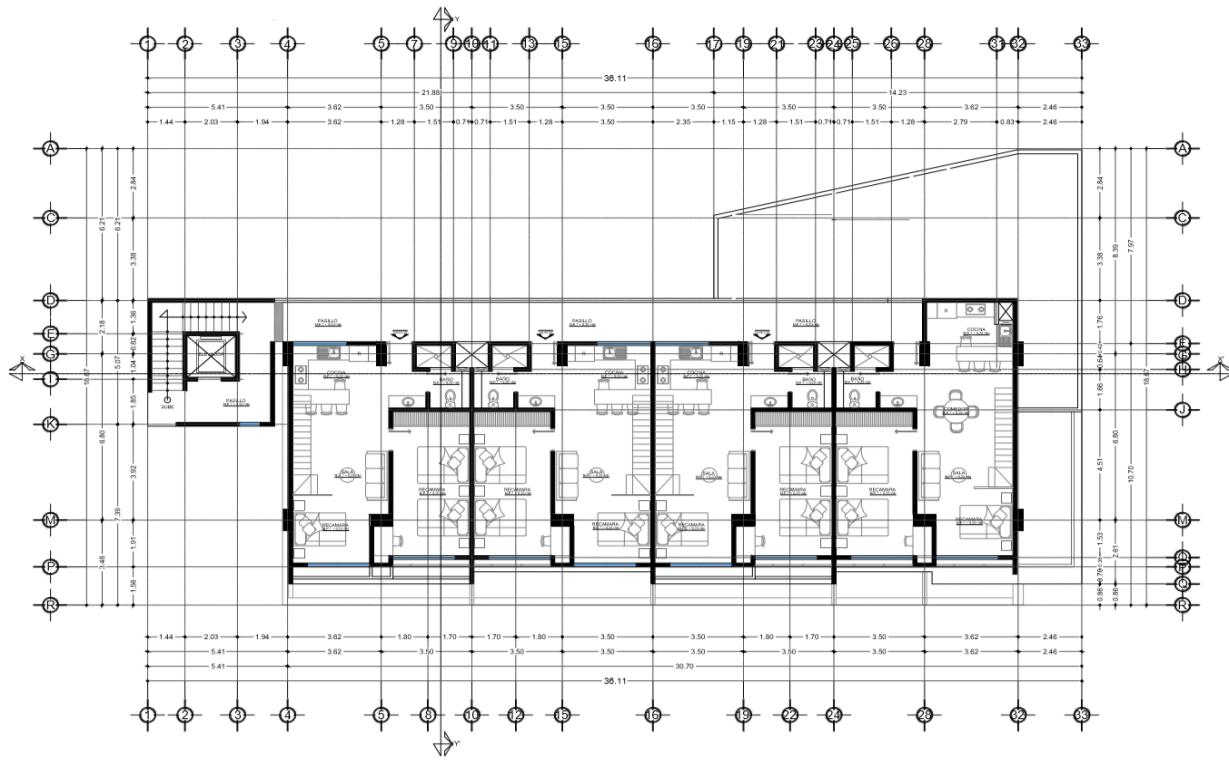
Planta arquitectónica del tercer nivel del Edificio B.
